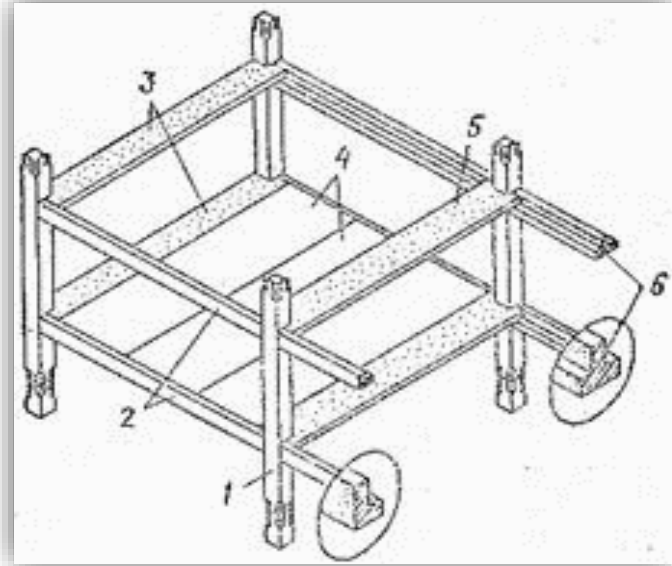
Конструктивные элементы сборного железобетонного каркаса гражданского здания
